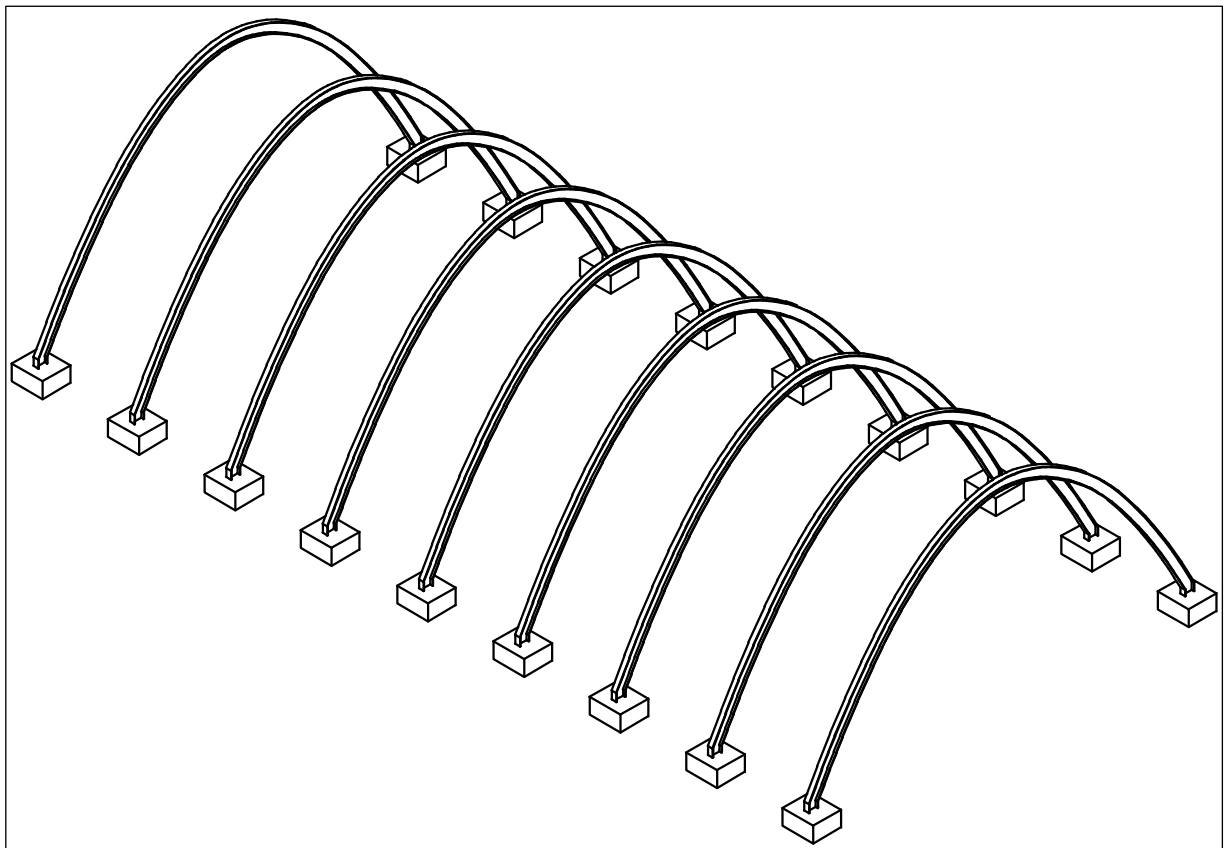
Esquema de los pórticos de la estructura metálica de la estación
